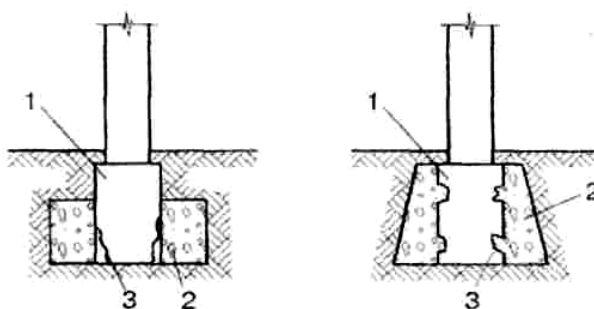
Схема підсилення фундаментів бетонними обоймами:
